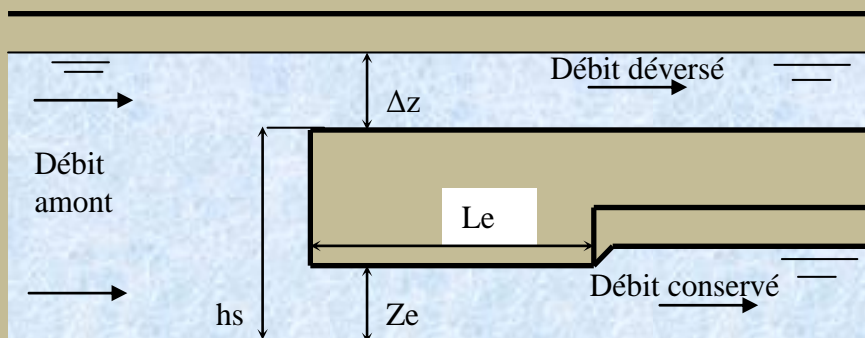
Vue en coupe du déversoir frontal à seuil haut.
